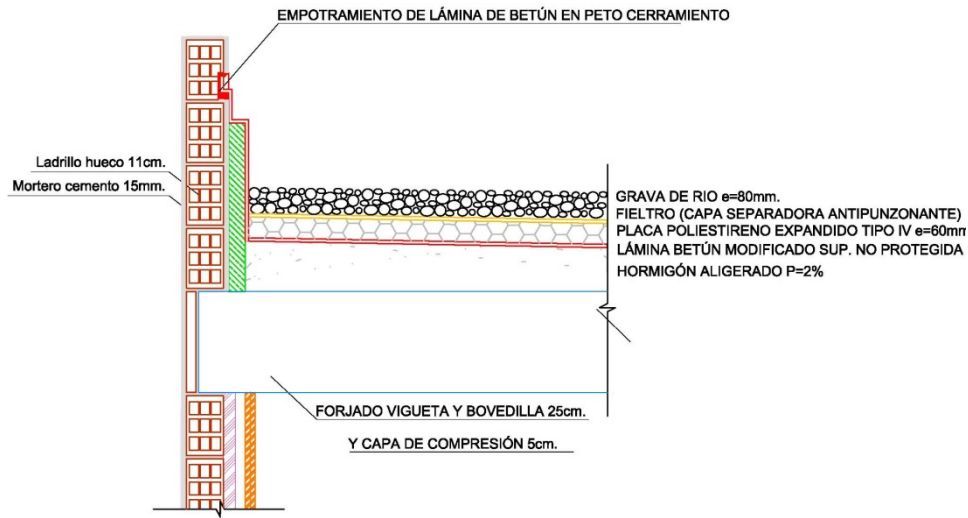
Detalle de la cubierta de la vivienda tradicional
